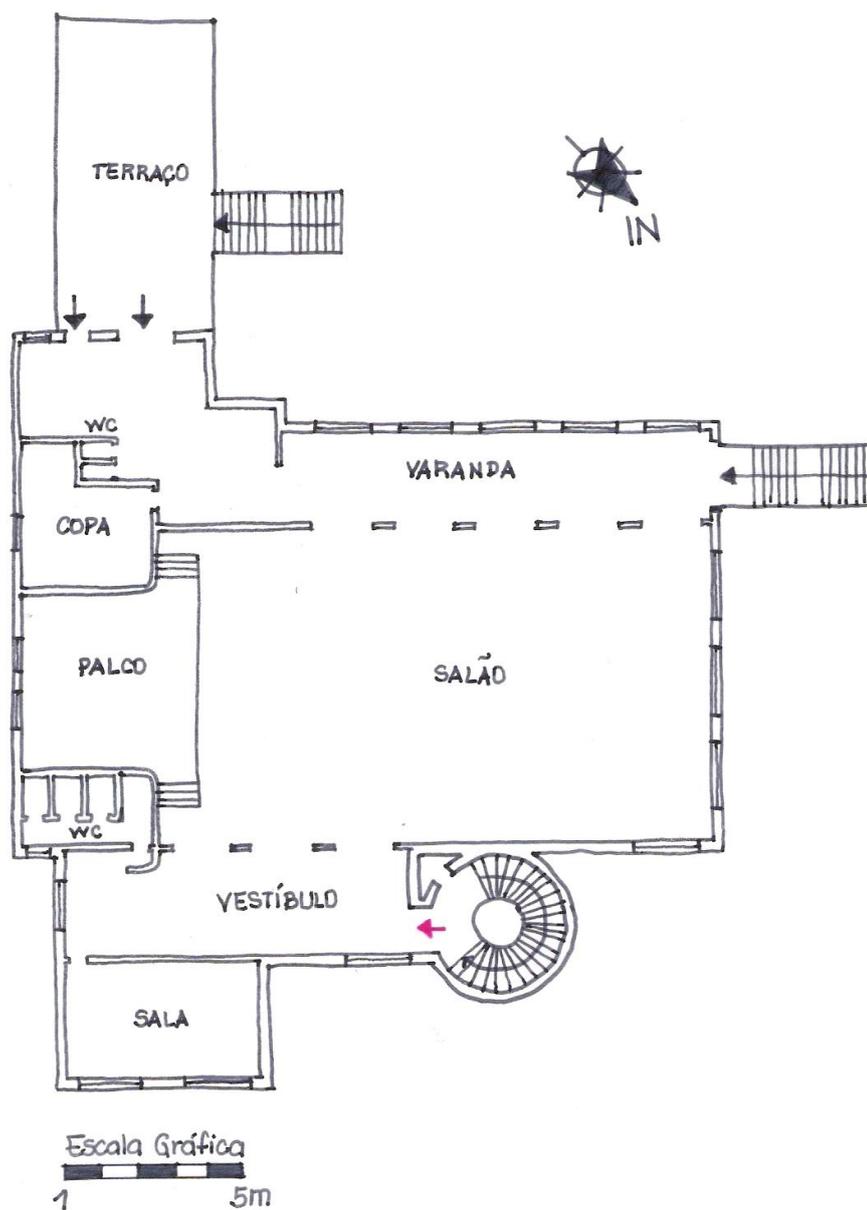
Planta Baixa esquemática da edificação – Pavimento superior.
